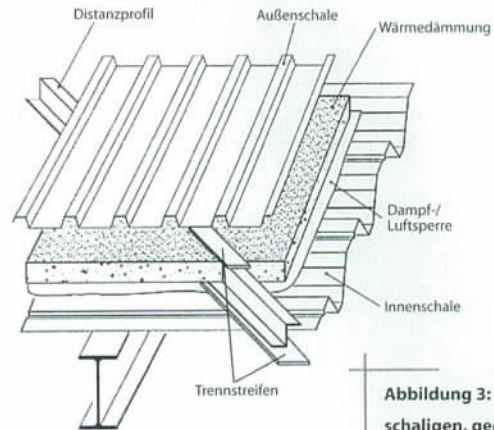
Aufbau eines zweischaligen, gedämmten Trapezprofildaches (Binderdach).
